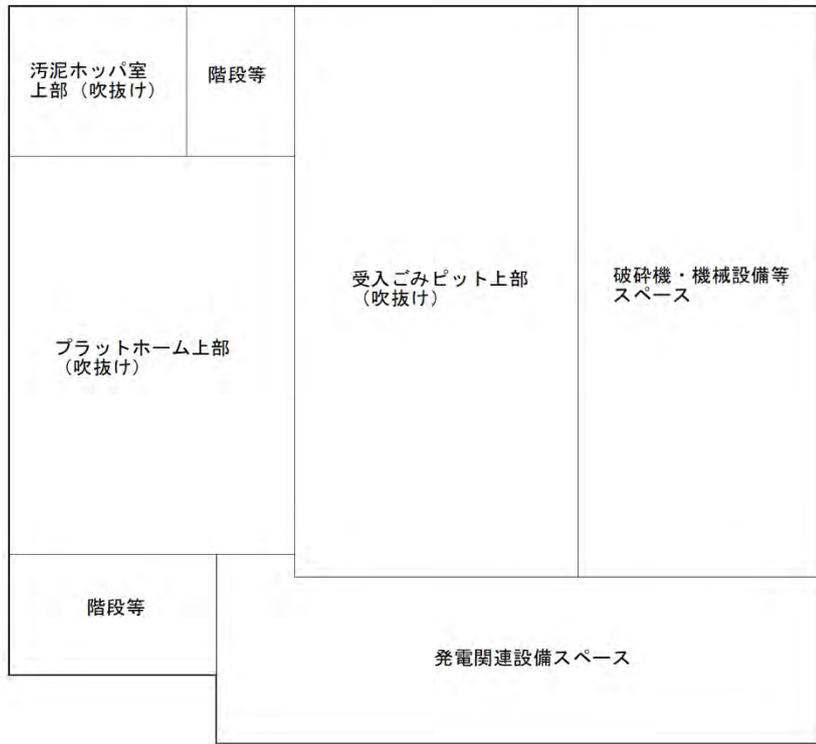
(3) 廃棄物受入棟平面図 (2 階)
